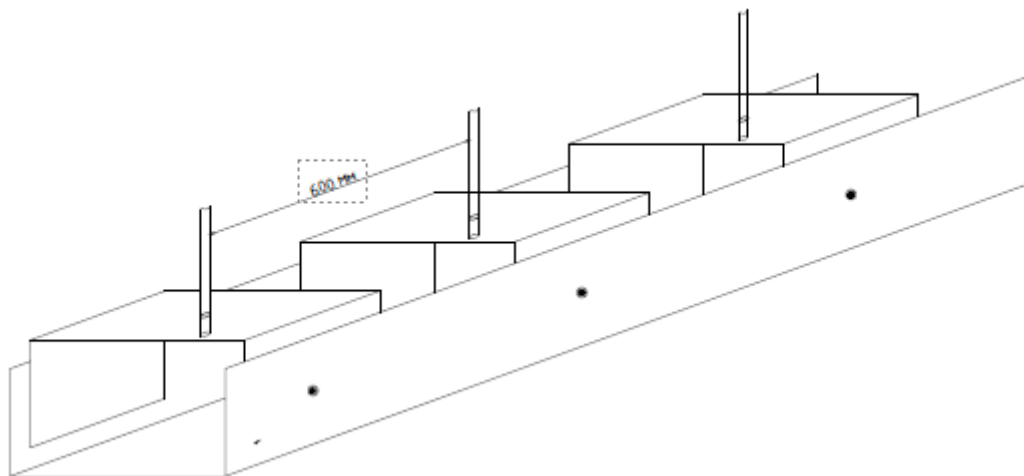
Монтаж нижнего профиля каркаса к предустановленным заготовкам, с фиксацией винтами
